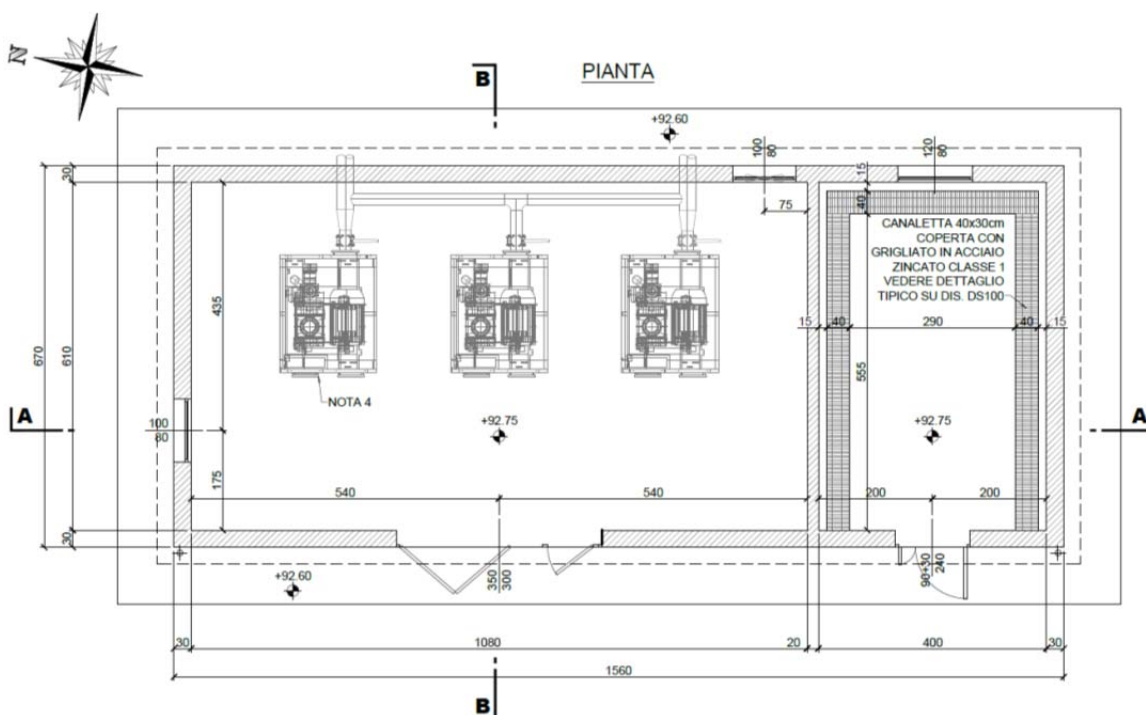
LOCALE SOFFIANTI – PIANTA
